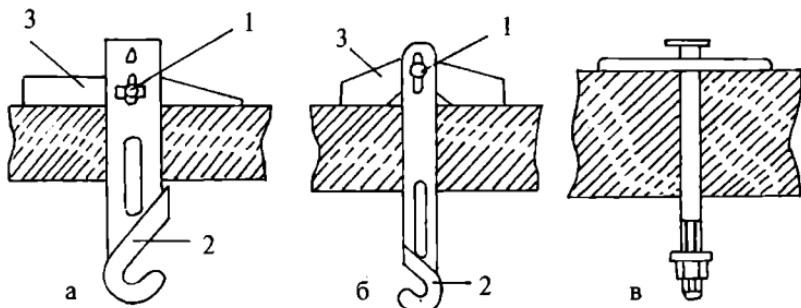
Арматура для крепления светильников: а — крюк У623; б — крюк У625; в — шпилька У632; 1 — ось; 2 — крюк с изолирующим колпаком; 3 — опорная планка
